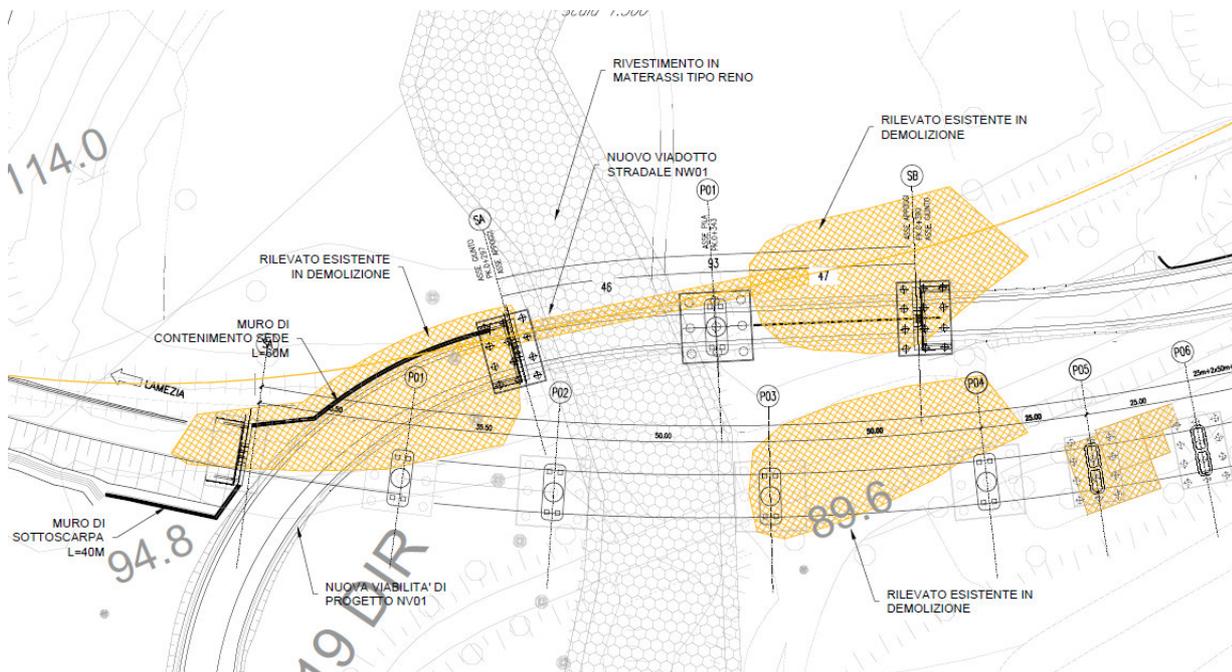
NW1 – Planimetria del viadotto stradale NW01
